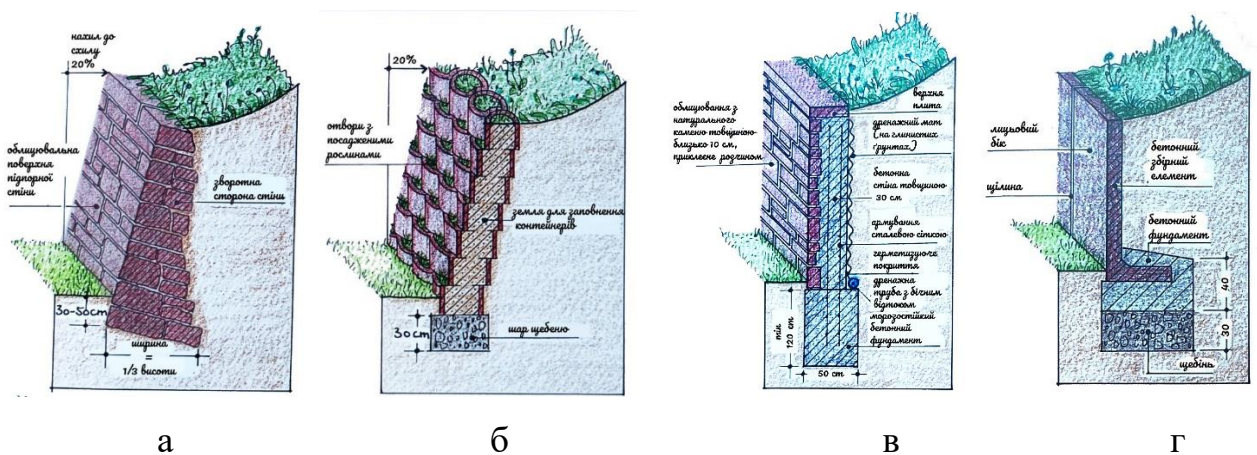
Підпірні стінки [39]: а) з натурального каменю; б) з бетонних збірних елементів; в) бетонна з облицюванням натуральним каменем; г) з бетонних збірних елементів L-подібної форми
